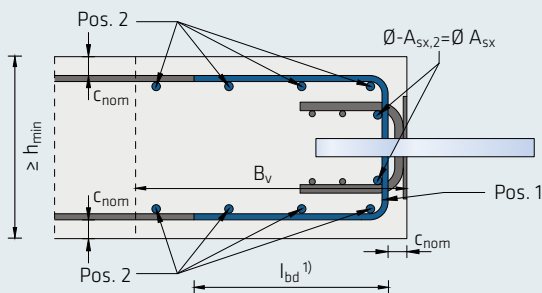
Zusatzbewehrung bei dicken Platten (zusätzlicher Splintstab bei angeschweißter Bewehrung)
